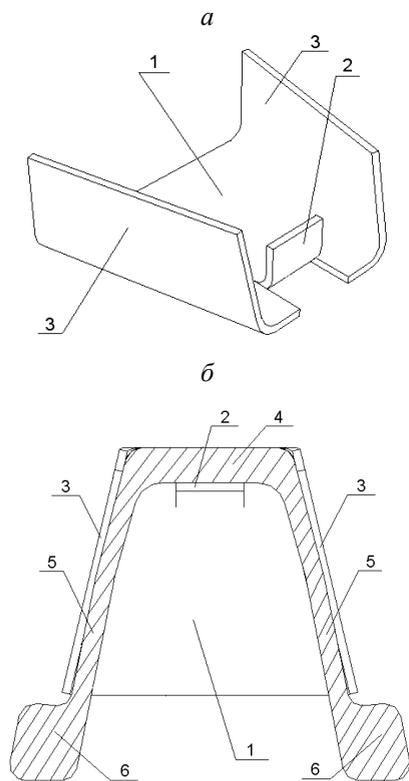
Опорный башмак БО-ДК: а – внешний вид; б – способ крепления на стойке
